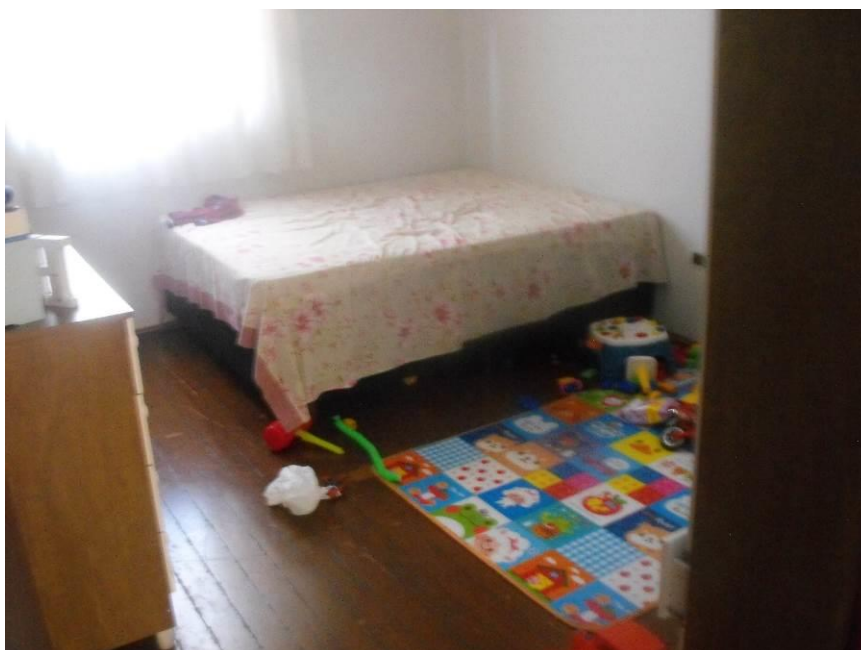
Mostrando um dormitório do pavimento superior do prédio.
